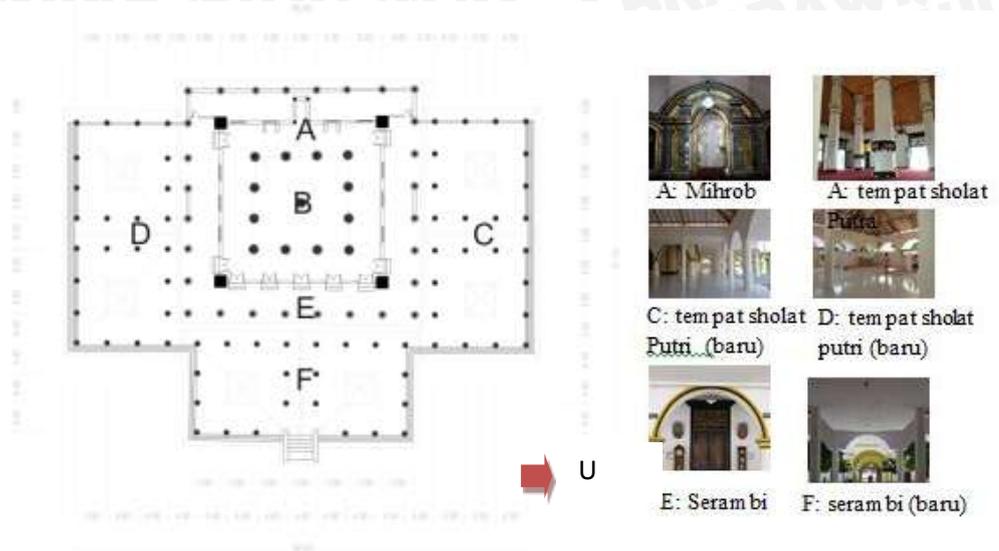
Perubahan denah bangunan Masjid Jamik Sumenep
